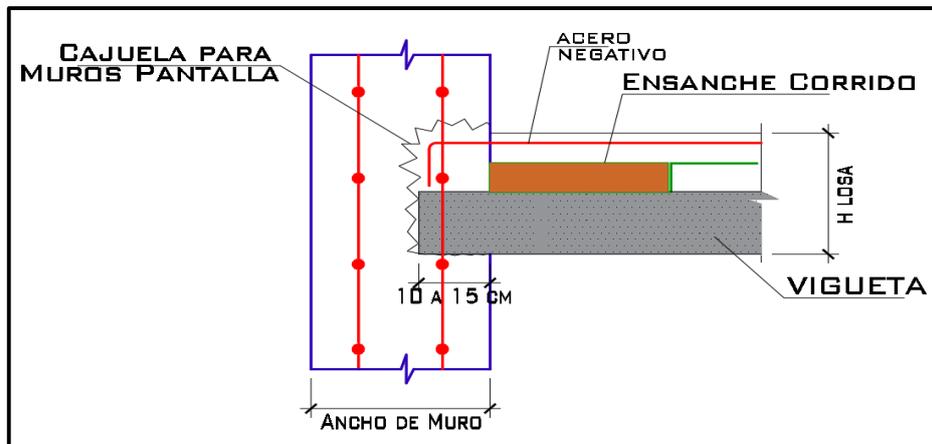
Detalle de ingreso de vigueta a muro pantalla.
